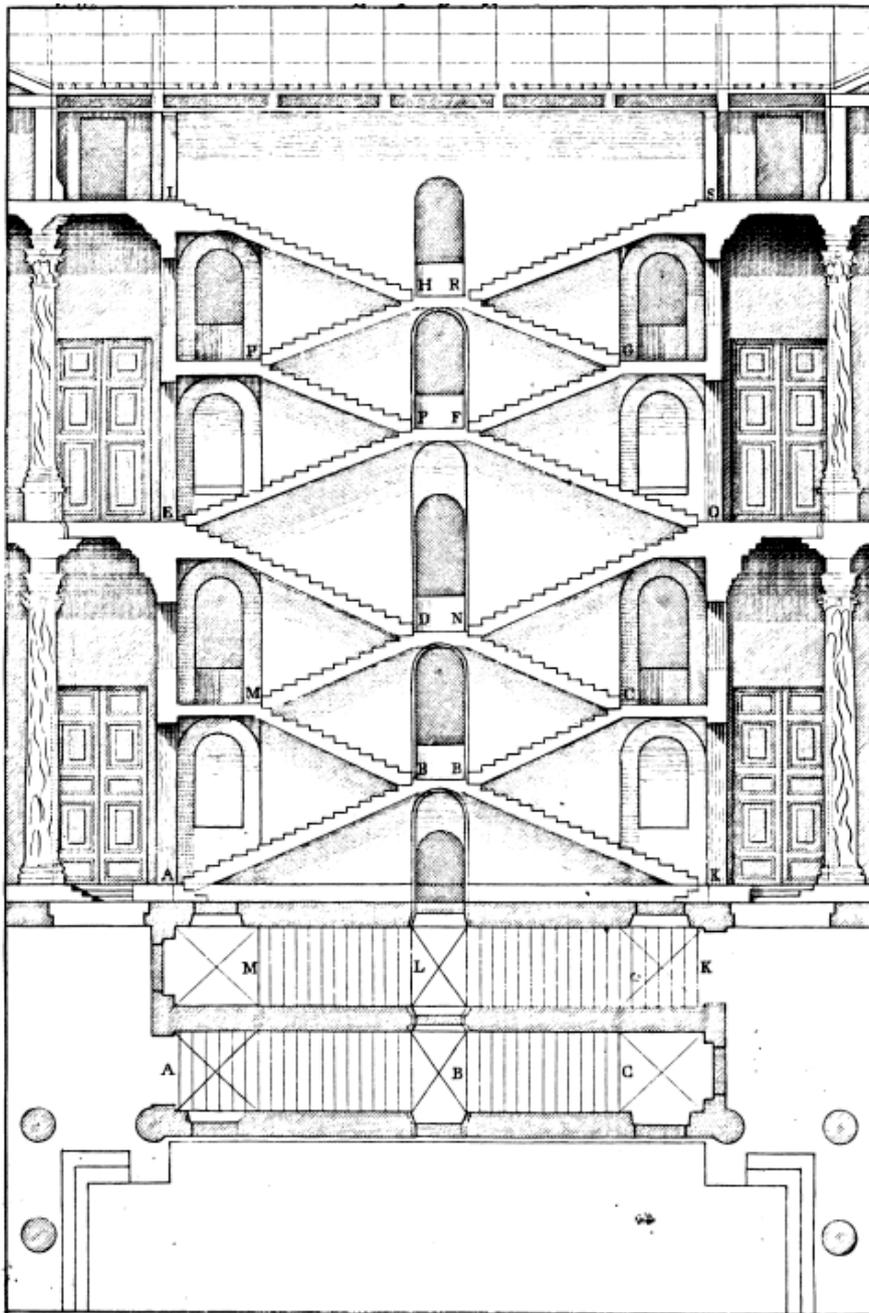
Pianta e sezione della scala doppia su impianto rettangolare, si compone di due rampe parallele con sviluppo indipendente (da Palladio, 1570, p. 62).
